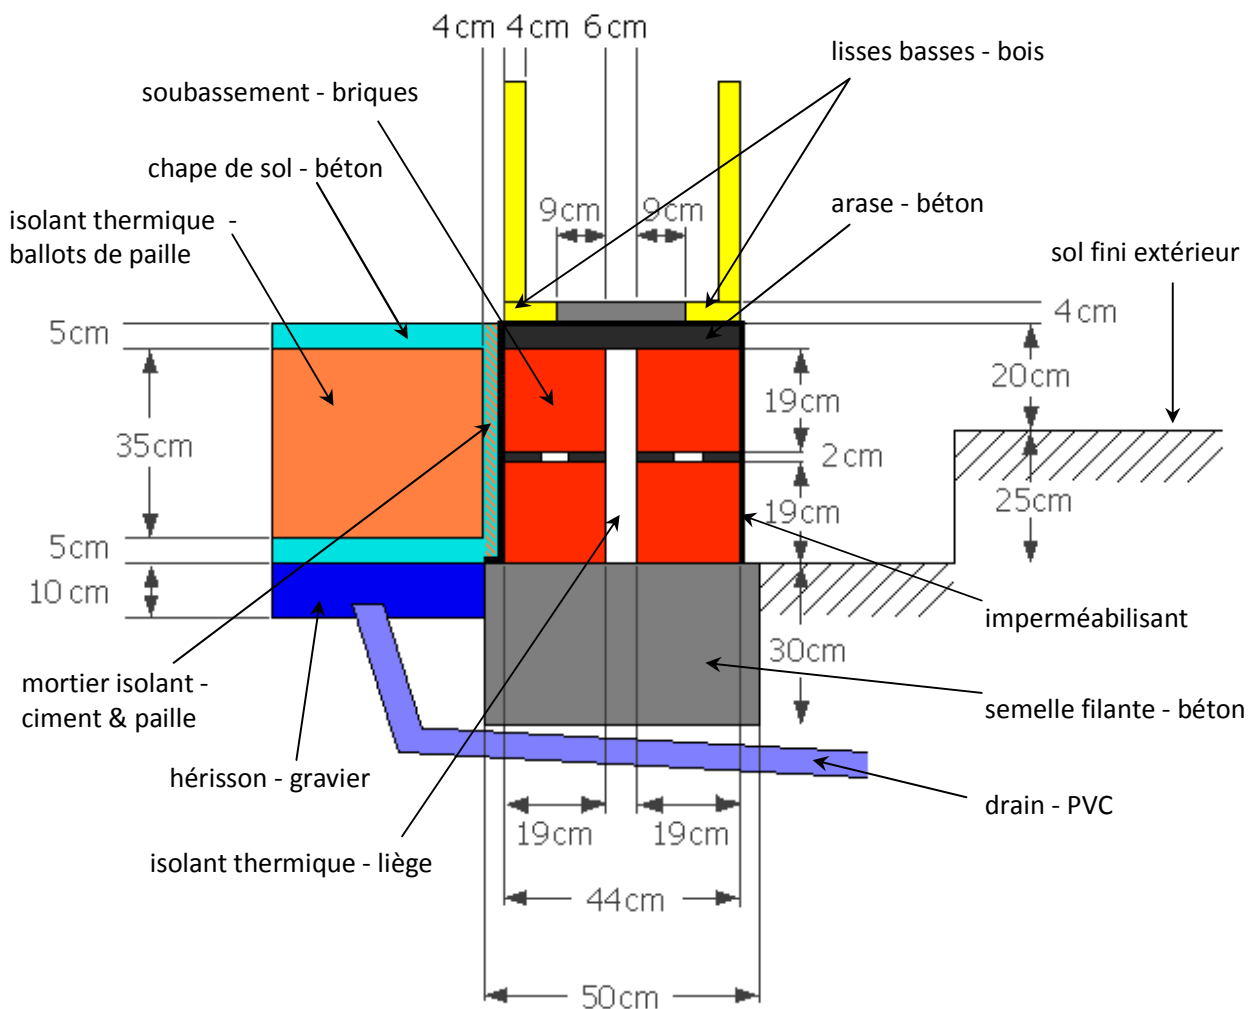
Coupe transversale des fondations, de la chape et du mur
